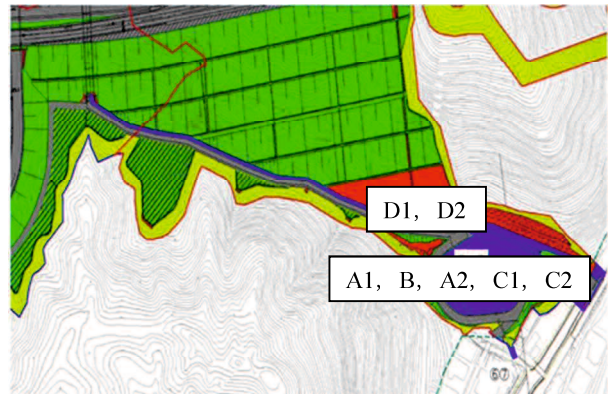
宝塚北 SA 盛土流量計測地点平面図
